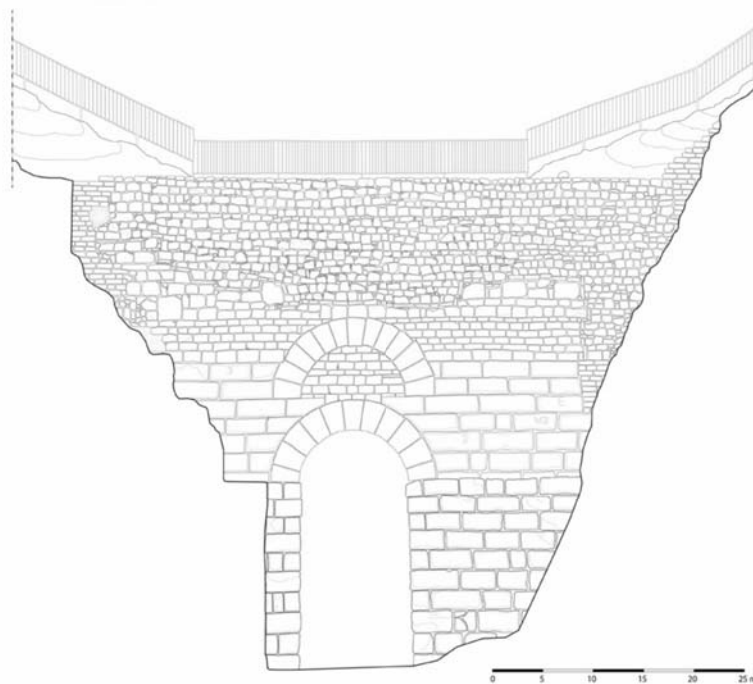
Rilievo del prospetto meridionale di Porta Rosa
